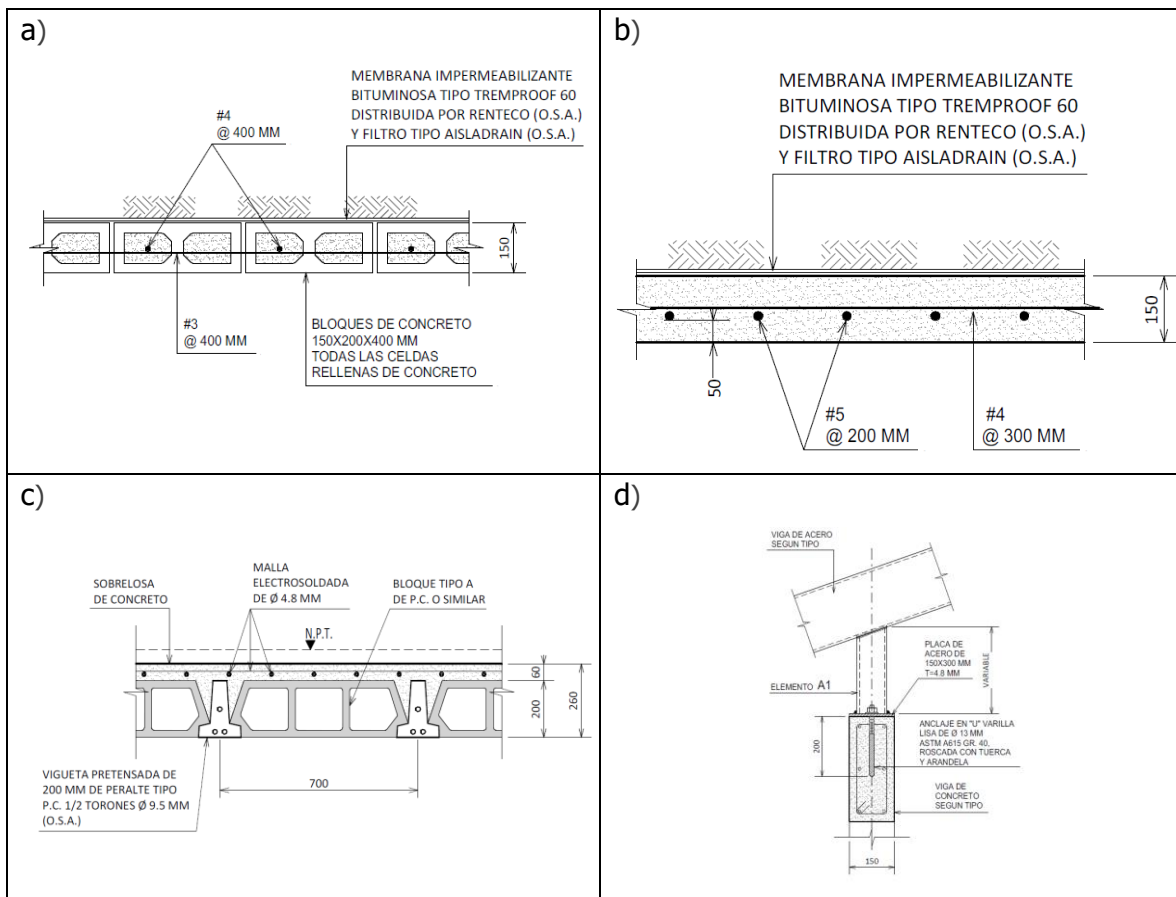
a) Muro de retención de mampostería. b) Muro de concreto. c) Losa de entrepiso. d) Unión entre viga corona y estructura de techo
